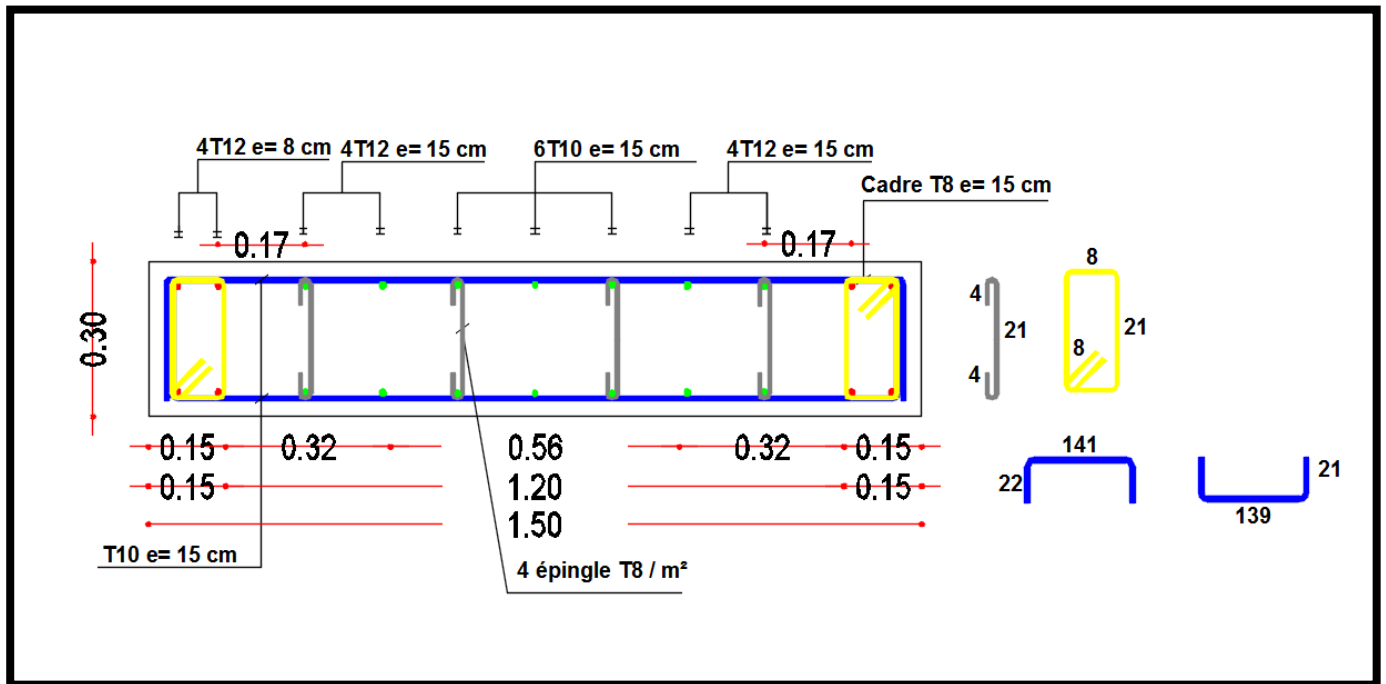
Coupe horizontale du ferrailage des voiles sens X-X type (1; 2; 3; 4)
